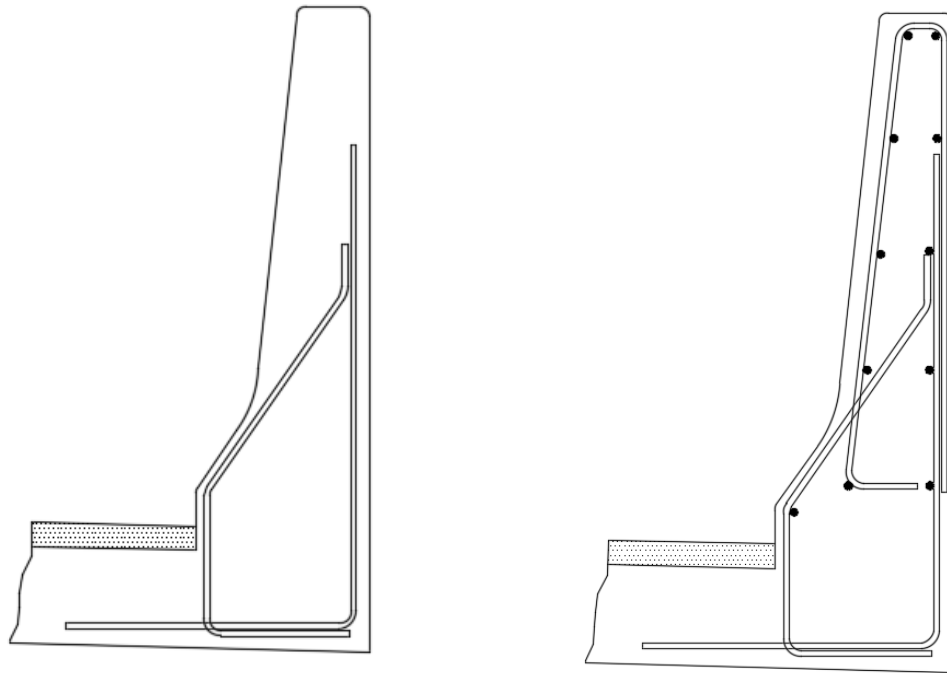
Construcción Barreras. Fuente: Elaboración Propia.
